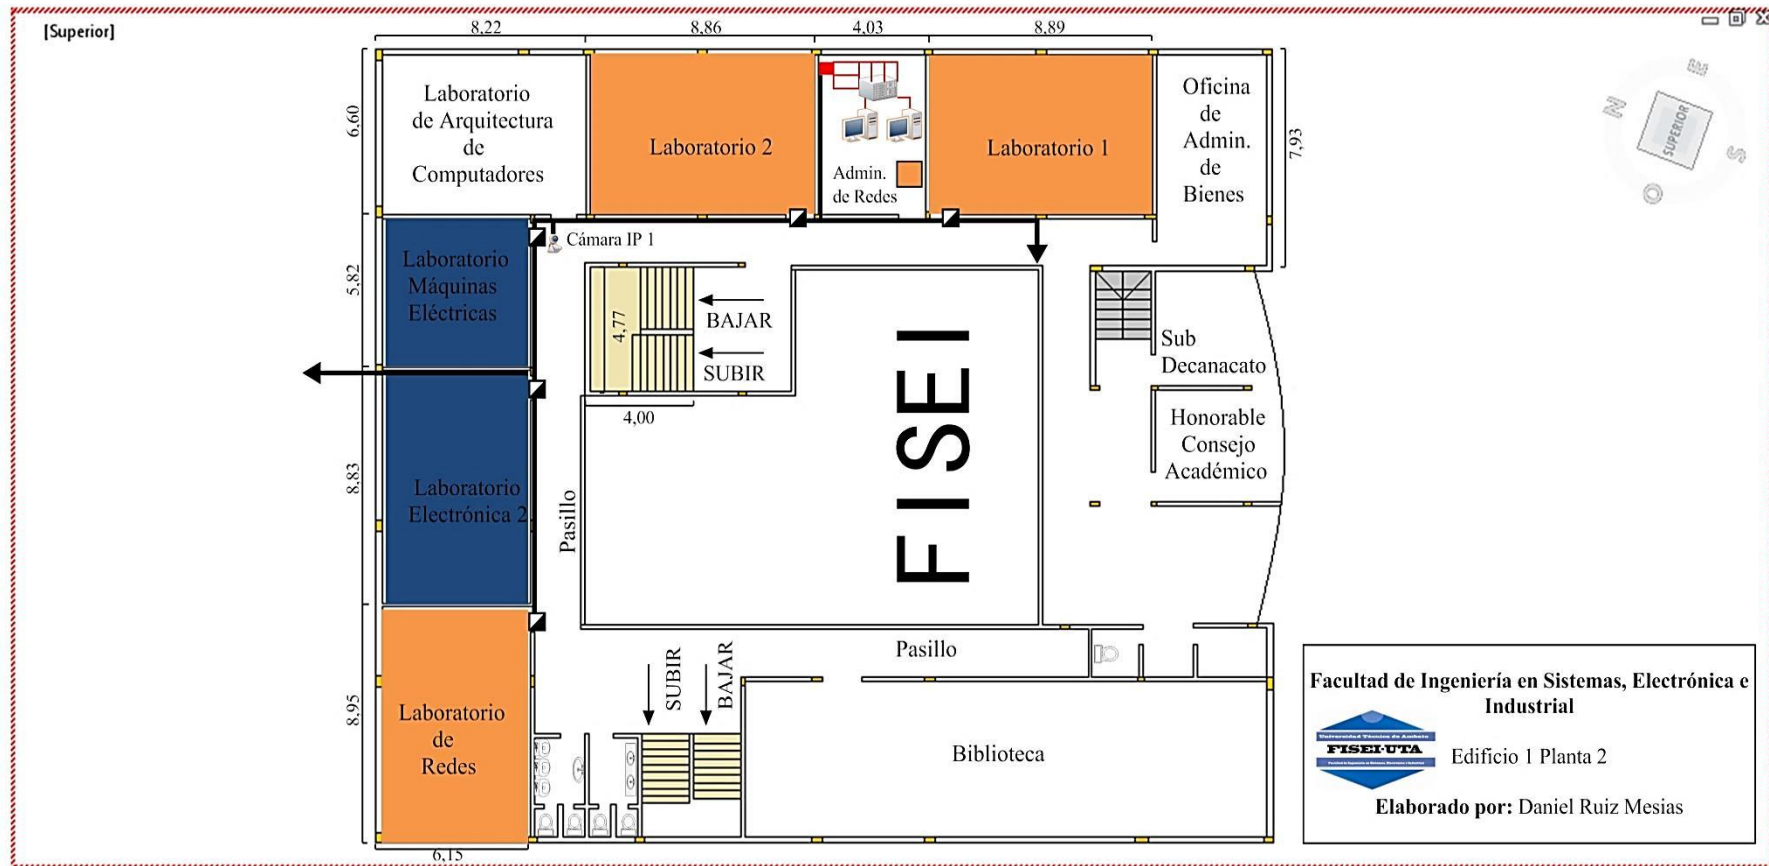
Distribución de elementos y cableado Edificio 1 Planta 2.
